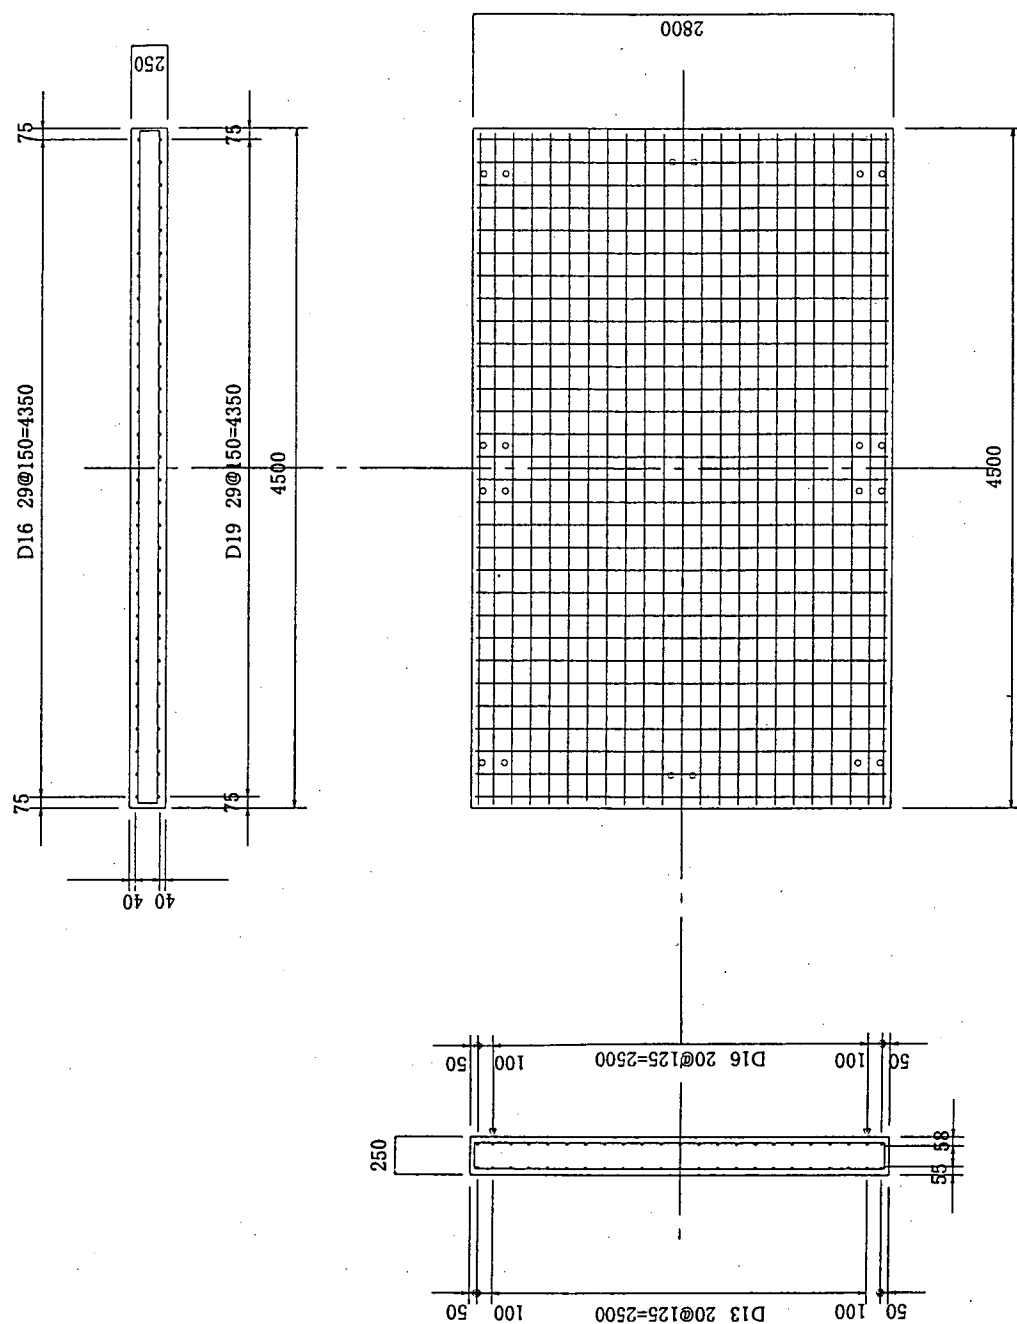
RC80供試体の形状・寸法 (単位:mm)
